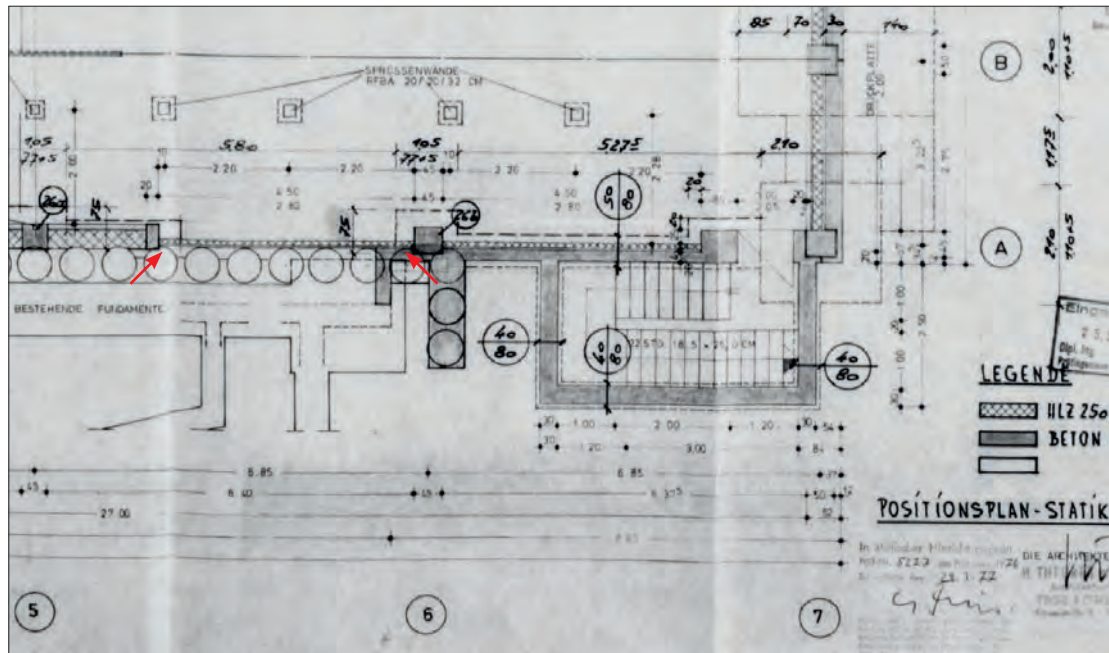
Werkplan – Grundriss/Positionsplan Statik 7306/P/73
